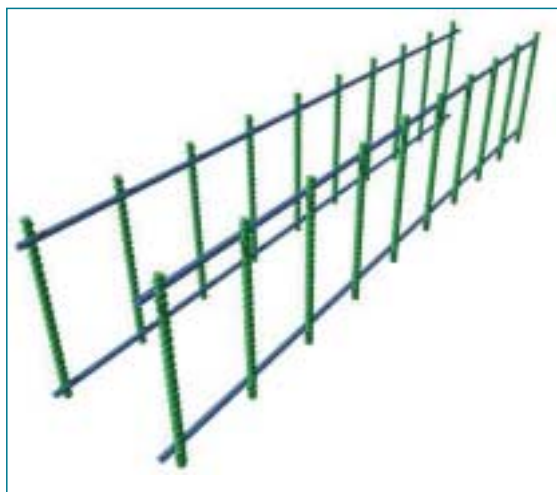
Armadura de corte de alto rendimiento con forma de escalera para vigas o losas.
